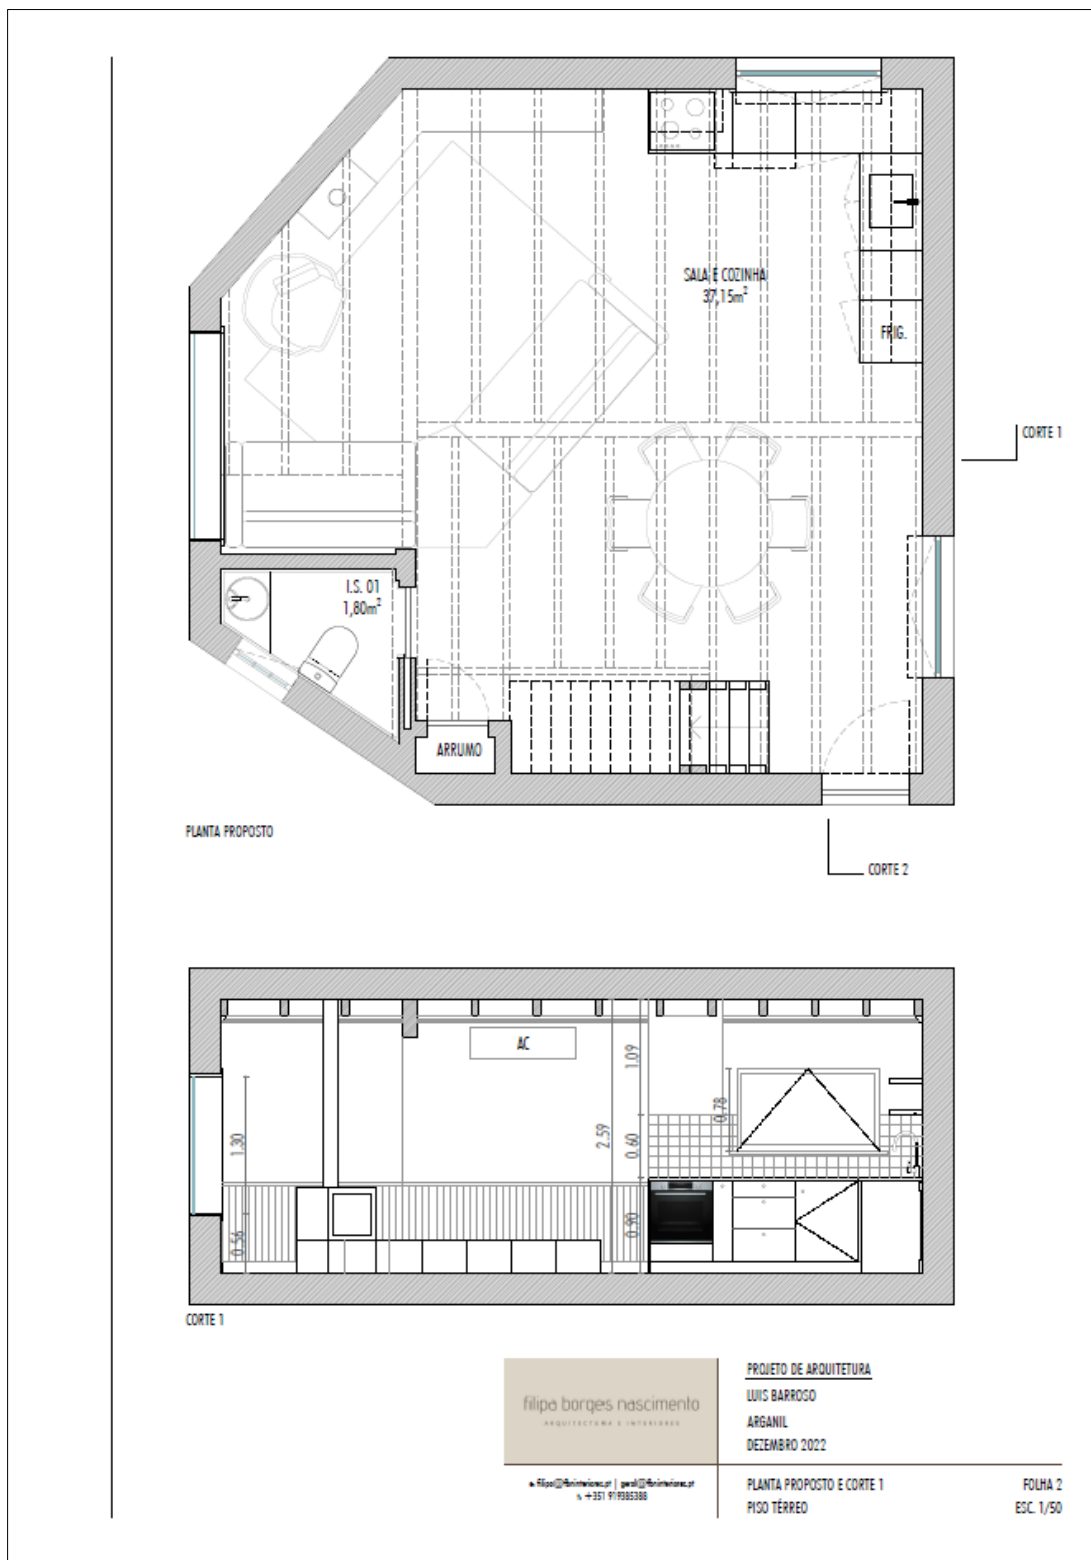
Planta proposta e corte 1 (Fonte: Ana Soares, 2022)
